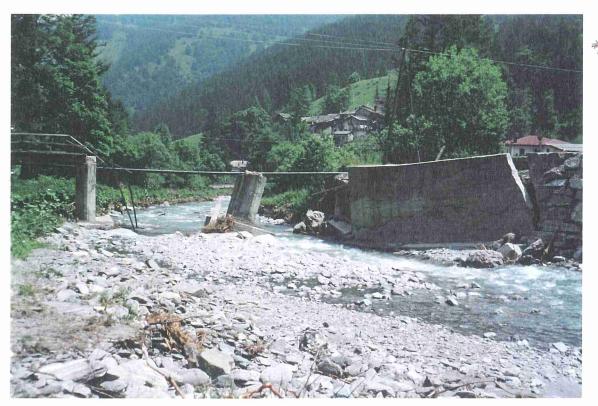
Torrente Germanasca - Comune di Praly – Località Ghigo Il ponte di accesso alla frazione Orgere, in calcestruzzo e legno è stato scalzato e distrutto in spalla destra e nella pila centrale (a causa delle fondazioni molto superficiali).
